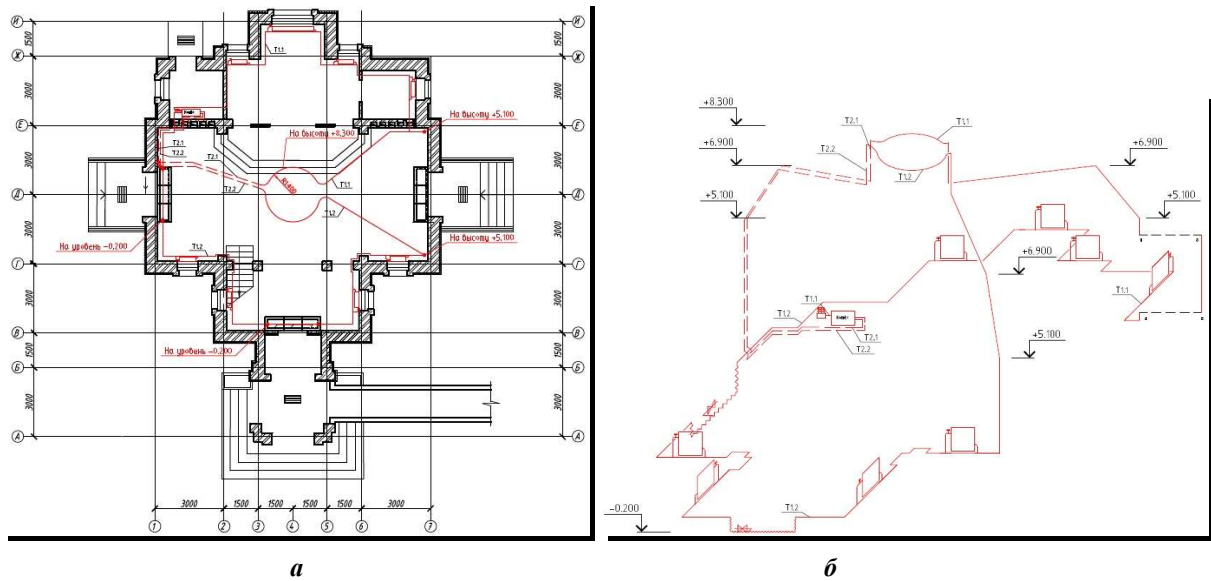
План церкви со схемой многоветвевой системы отопления и аксонометрическая схема
